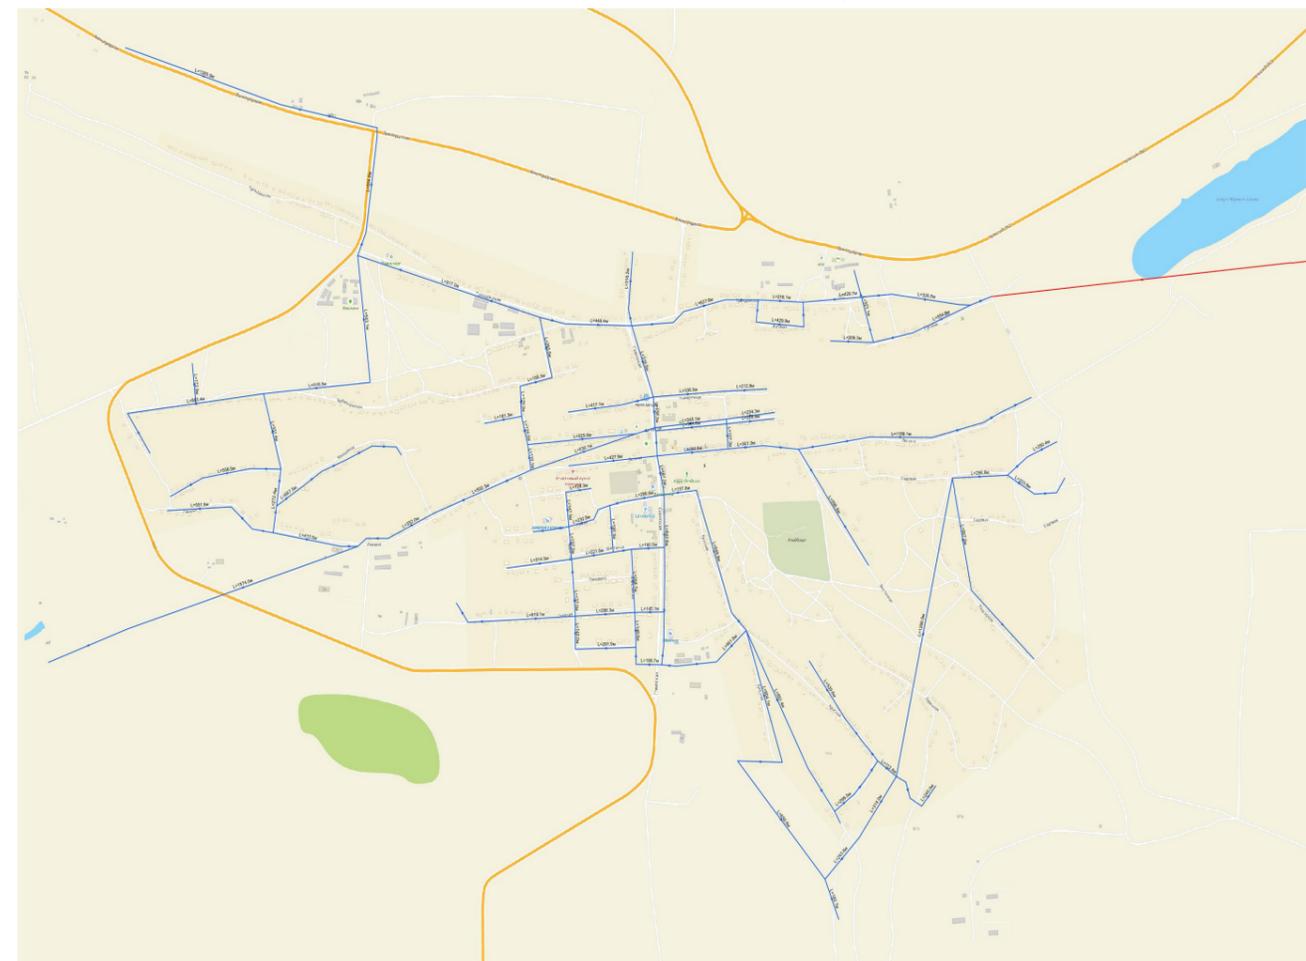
Схема водоснабжения с. Гофицкое
